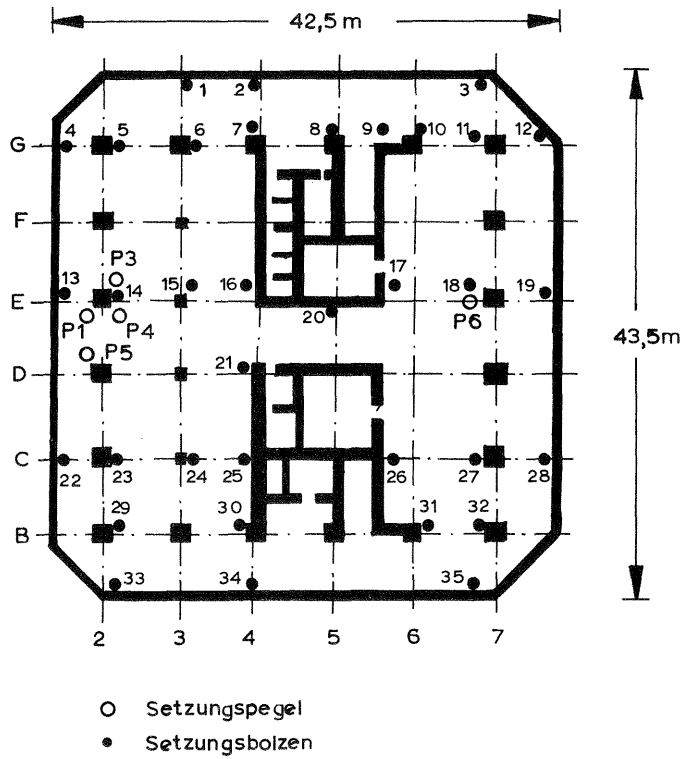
Grundriß der Fundamentplatte mit Meßeinrichtungen
